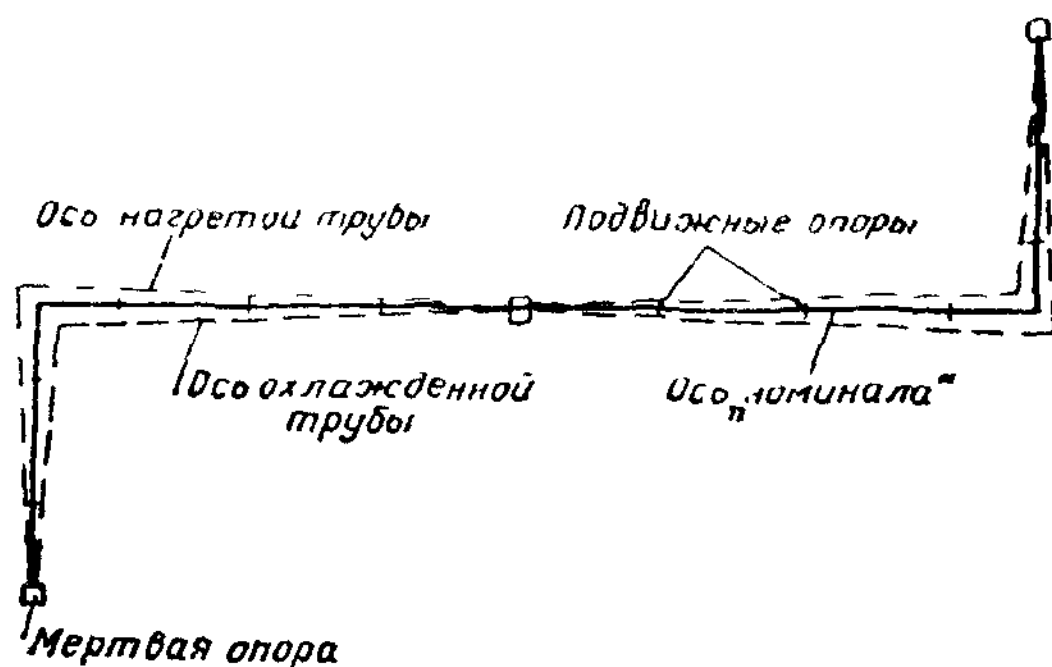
Схема самокомпенсирующегося трубопровода (без компенсаторов)
